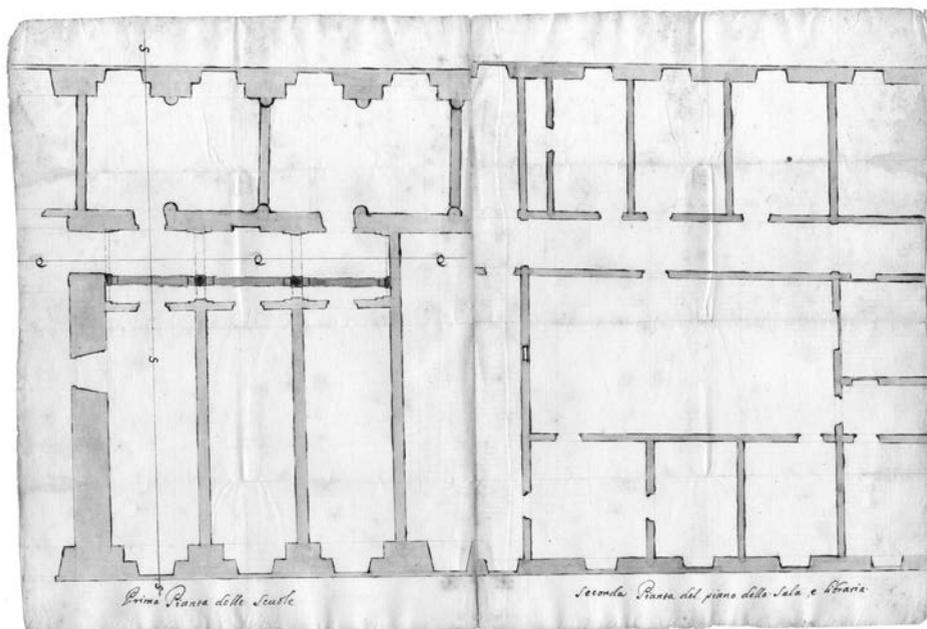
Planimetria del collegio nell'anno 1680 (ARSI, FGC, 1526, fasc. 5, n. 10).
